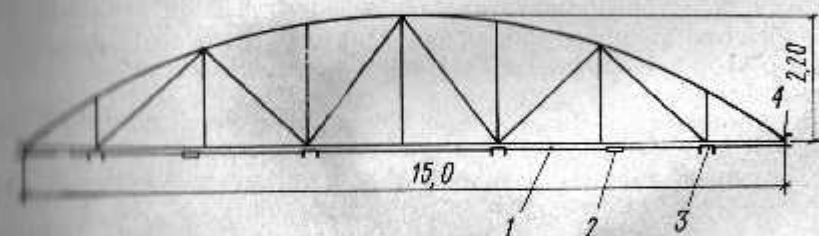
Схема усиления сегментных ферм, $l=15$ м
